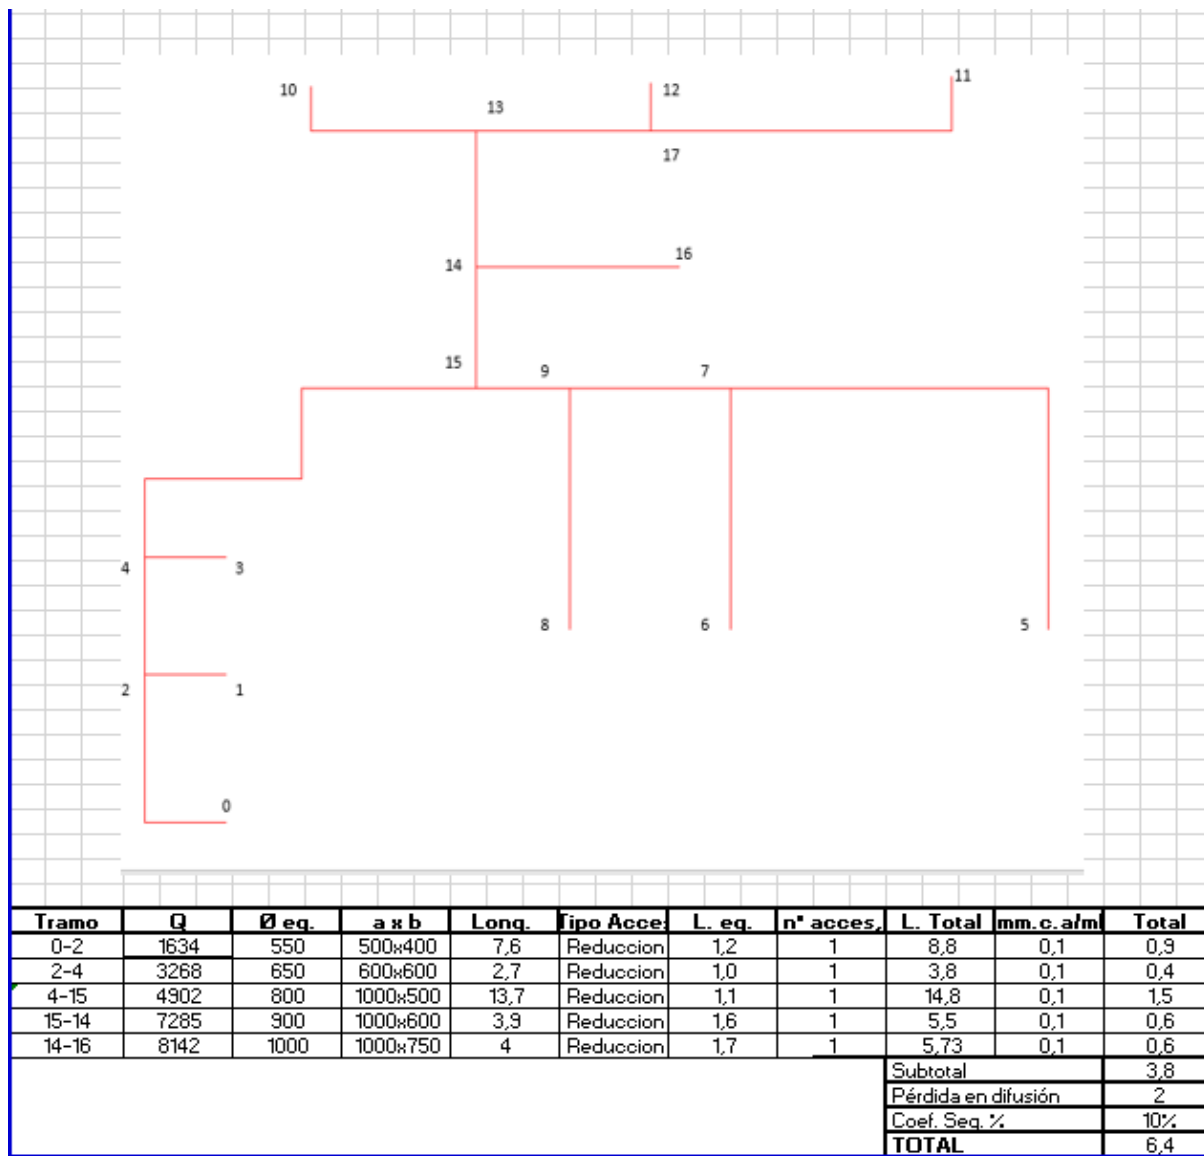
Conductos de extracción. Tramo más desfavorable. Planta baja.
